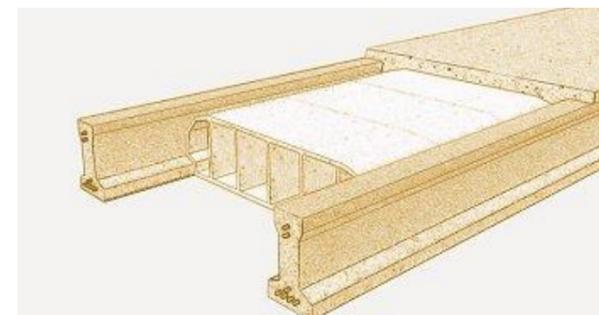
Perspectiva forjado tipo con bovedilla cerámica.
